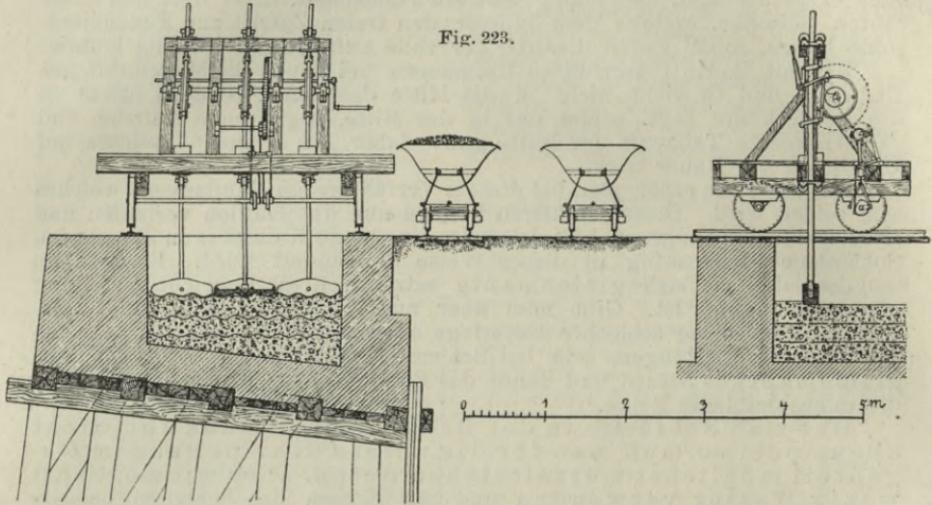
zeigt eine solche Anlage, welche Vering zum Stampfen des Betons in den Aussparungen der Kaimauern für die Hafenanlagen in Bremen verwendete und die sich gut bewährte. Sie besteht aus einem Gerüst, welches auf einem Gleis läuft. In dem Gerüst hängen 3 Stampfer mit wellenförmigen unteren Flächen nebeneinander, welche mittels eines durch 4 Mann zu bedienenden Windwerkes (versehen mit Hebelverbindungen, Mitnahmescheiben und Ausrückvorrichtungen) 0,30 m von der Betonoberfläche abgehoben werden und dann kurz hintereinander frei herabfallen. Das Fallgewicht dieser Stampfer betrug 60 bis 120 kg bei 0,2 bis 0,4 qm Grundfläche. Durch eine entsprechende Verbindung des Windwerkes mit einer Laufachse des Gerüstes wurde nach jedesmaligem Anheben und Fallen der drei Stampfer eine Vorwärtsbewegung des ganzen Gerüstes mittels Einrückens einer der beiden vorhandenen Sperrklinken
